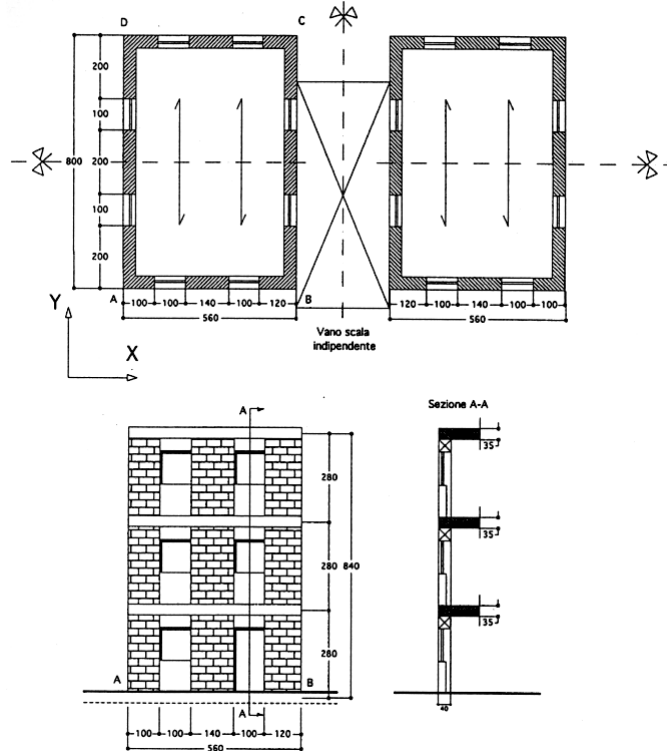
Pianta del piano tipo, prospetto e sezione dell'edificio.
